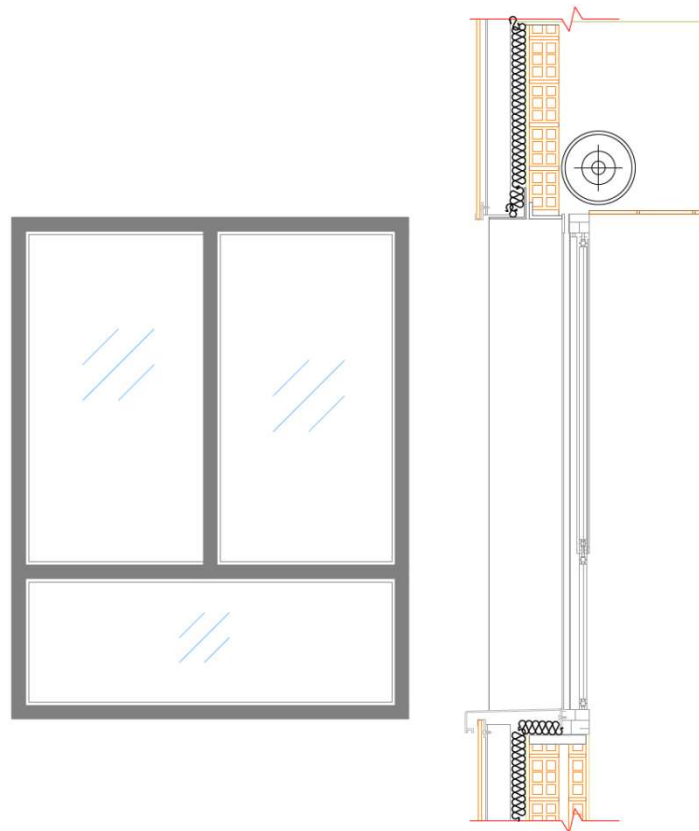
Alzado y sección nueva carpintería aluminio de ventanas, (Fuente: autor)
